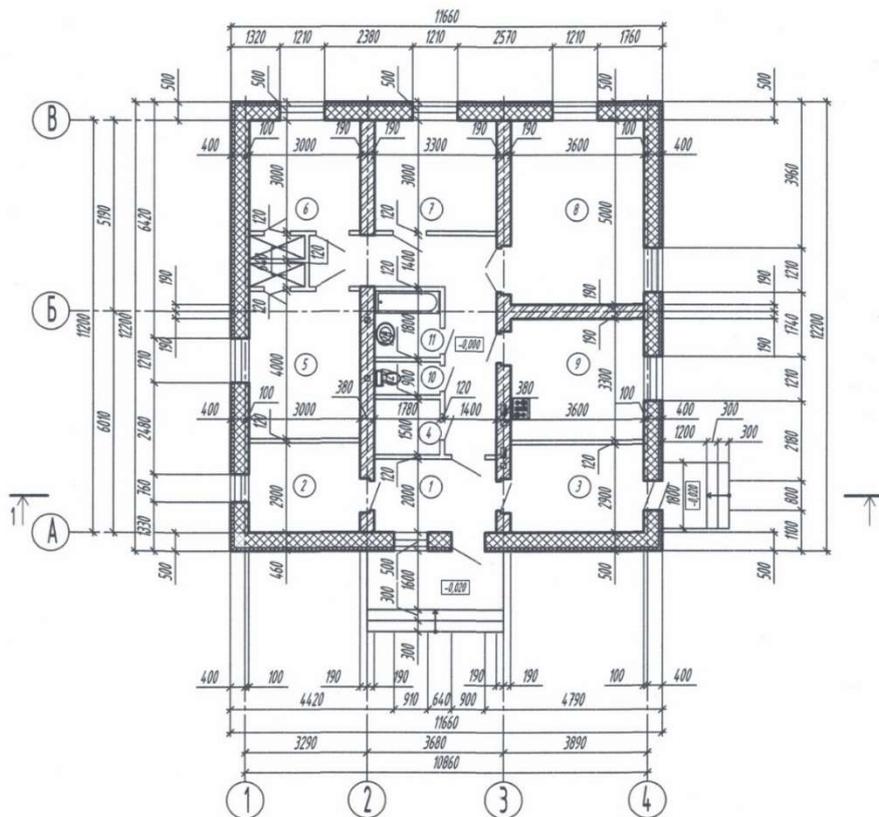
План этажа одноквартирного жилого дома на отм. 0,000
